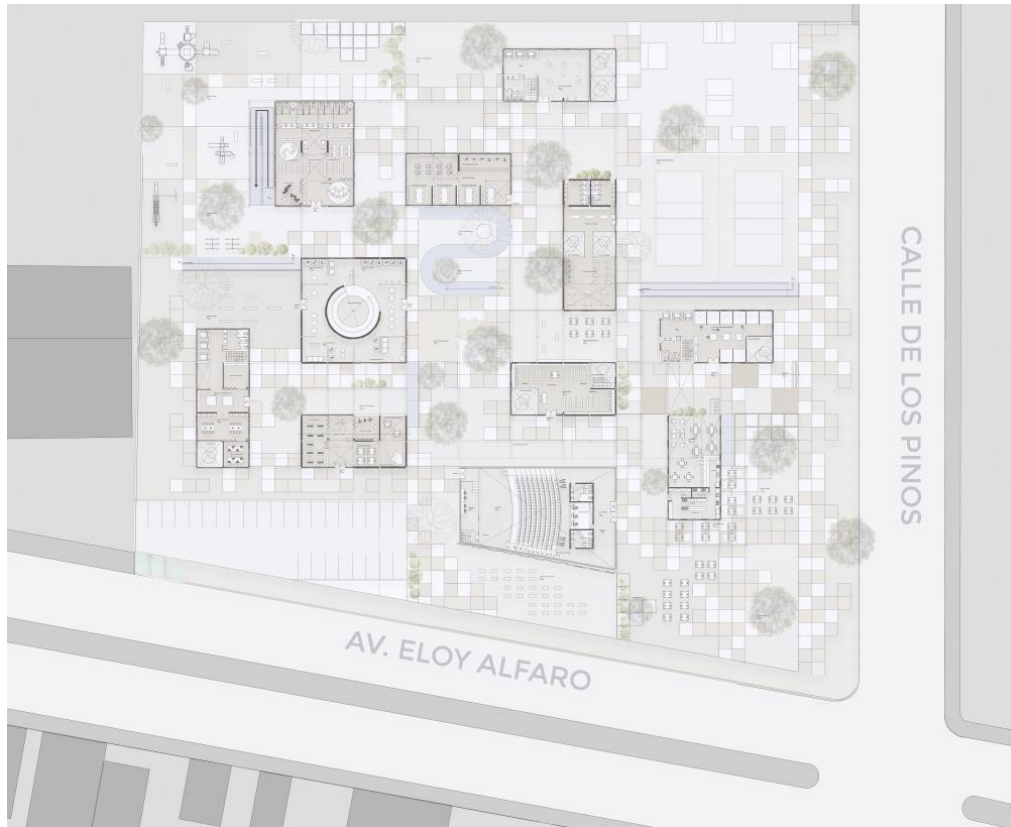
Planta Baja ± 0.00 . Elaboración propia.
